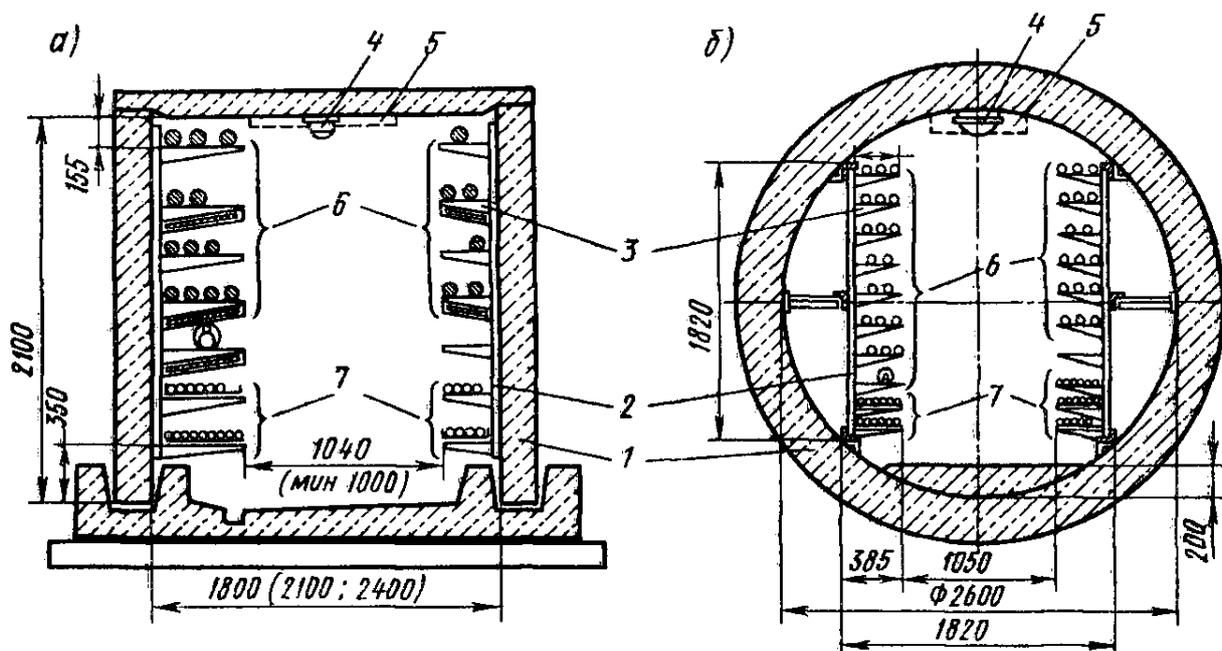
Раскладка кабеля: а - туннель прямоугольного сечения; б - туннель круглого сечения; 1 - блок туннеля; 2 - стойка; 3 - полка; 4 - светильник; 5 - зона пожароизвещателей и трубопроводов механизированной уборки пыли и пожаротушения; 6 - силовые кабели; 7 - контрольные кабели
